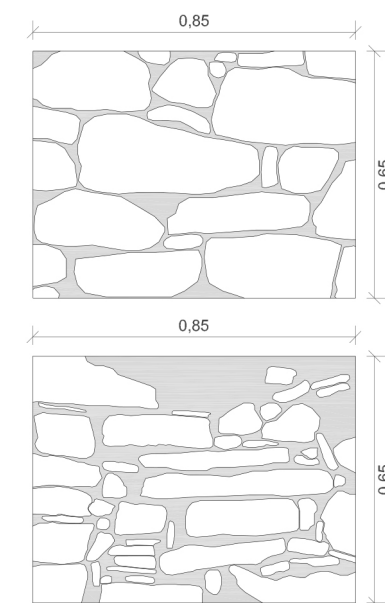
Caserío Barrenetxea, comparación de la construcción de la mampostería barroca (arriba) y la renacentista (abajo). E: 1/20.
